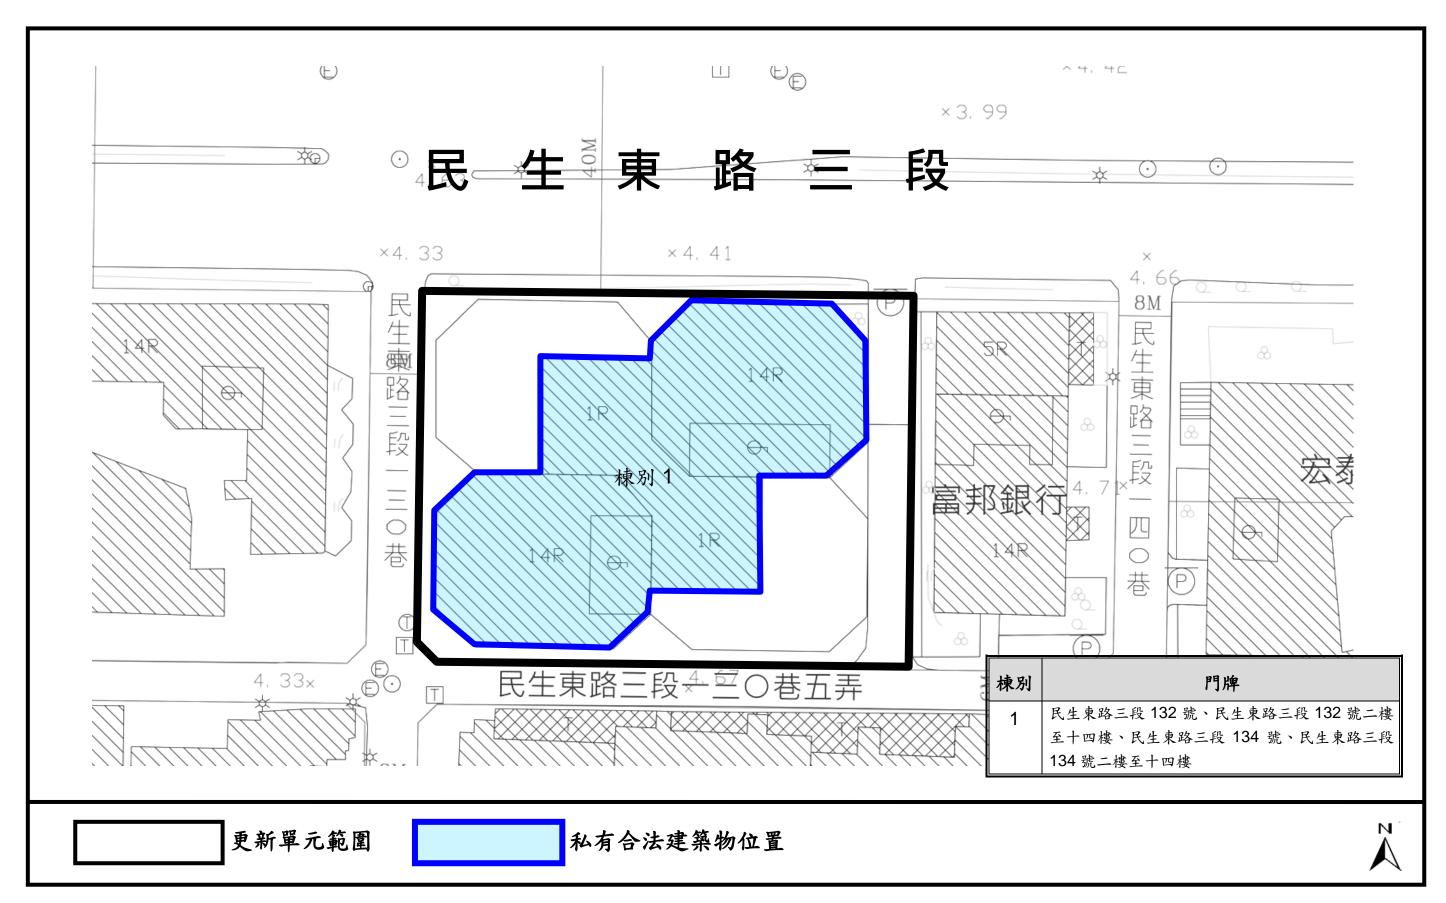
合法建築物分布位置示意圖 (S:1/500)
